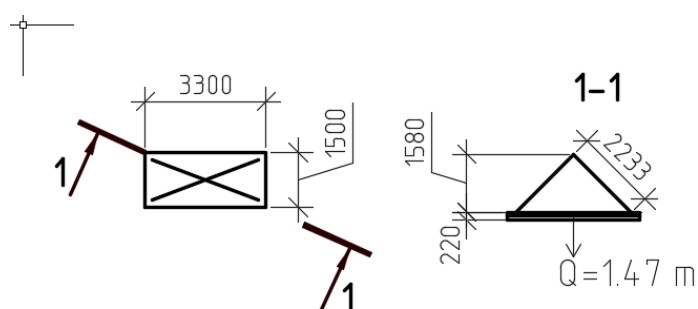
Определение длины стропы для монтажа наиболее удаленной плиты перекрытия
